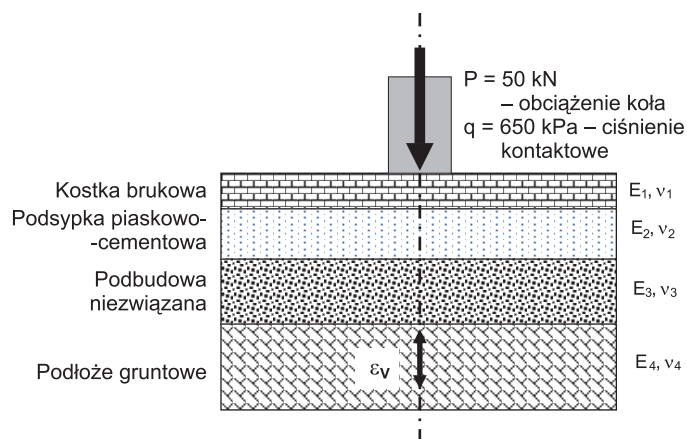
Konstrukcja nawierzchni Krakowskiego Przedmieścia, wg projektu
